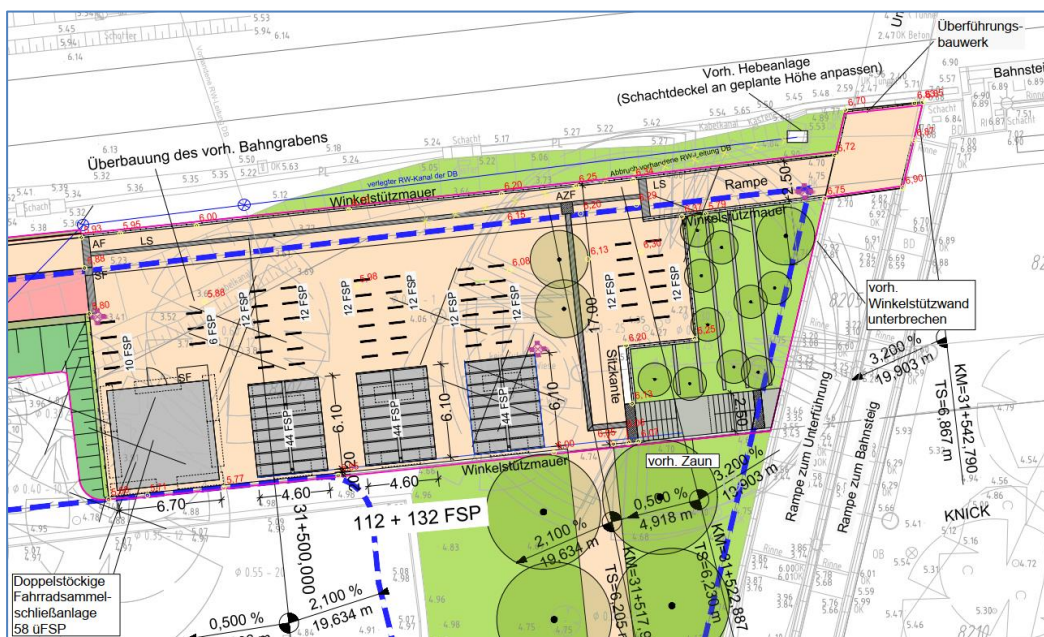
Lageplanausschnitt Vorplatz mit Fahrradabstellanlage (informativ)
